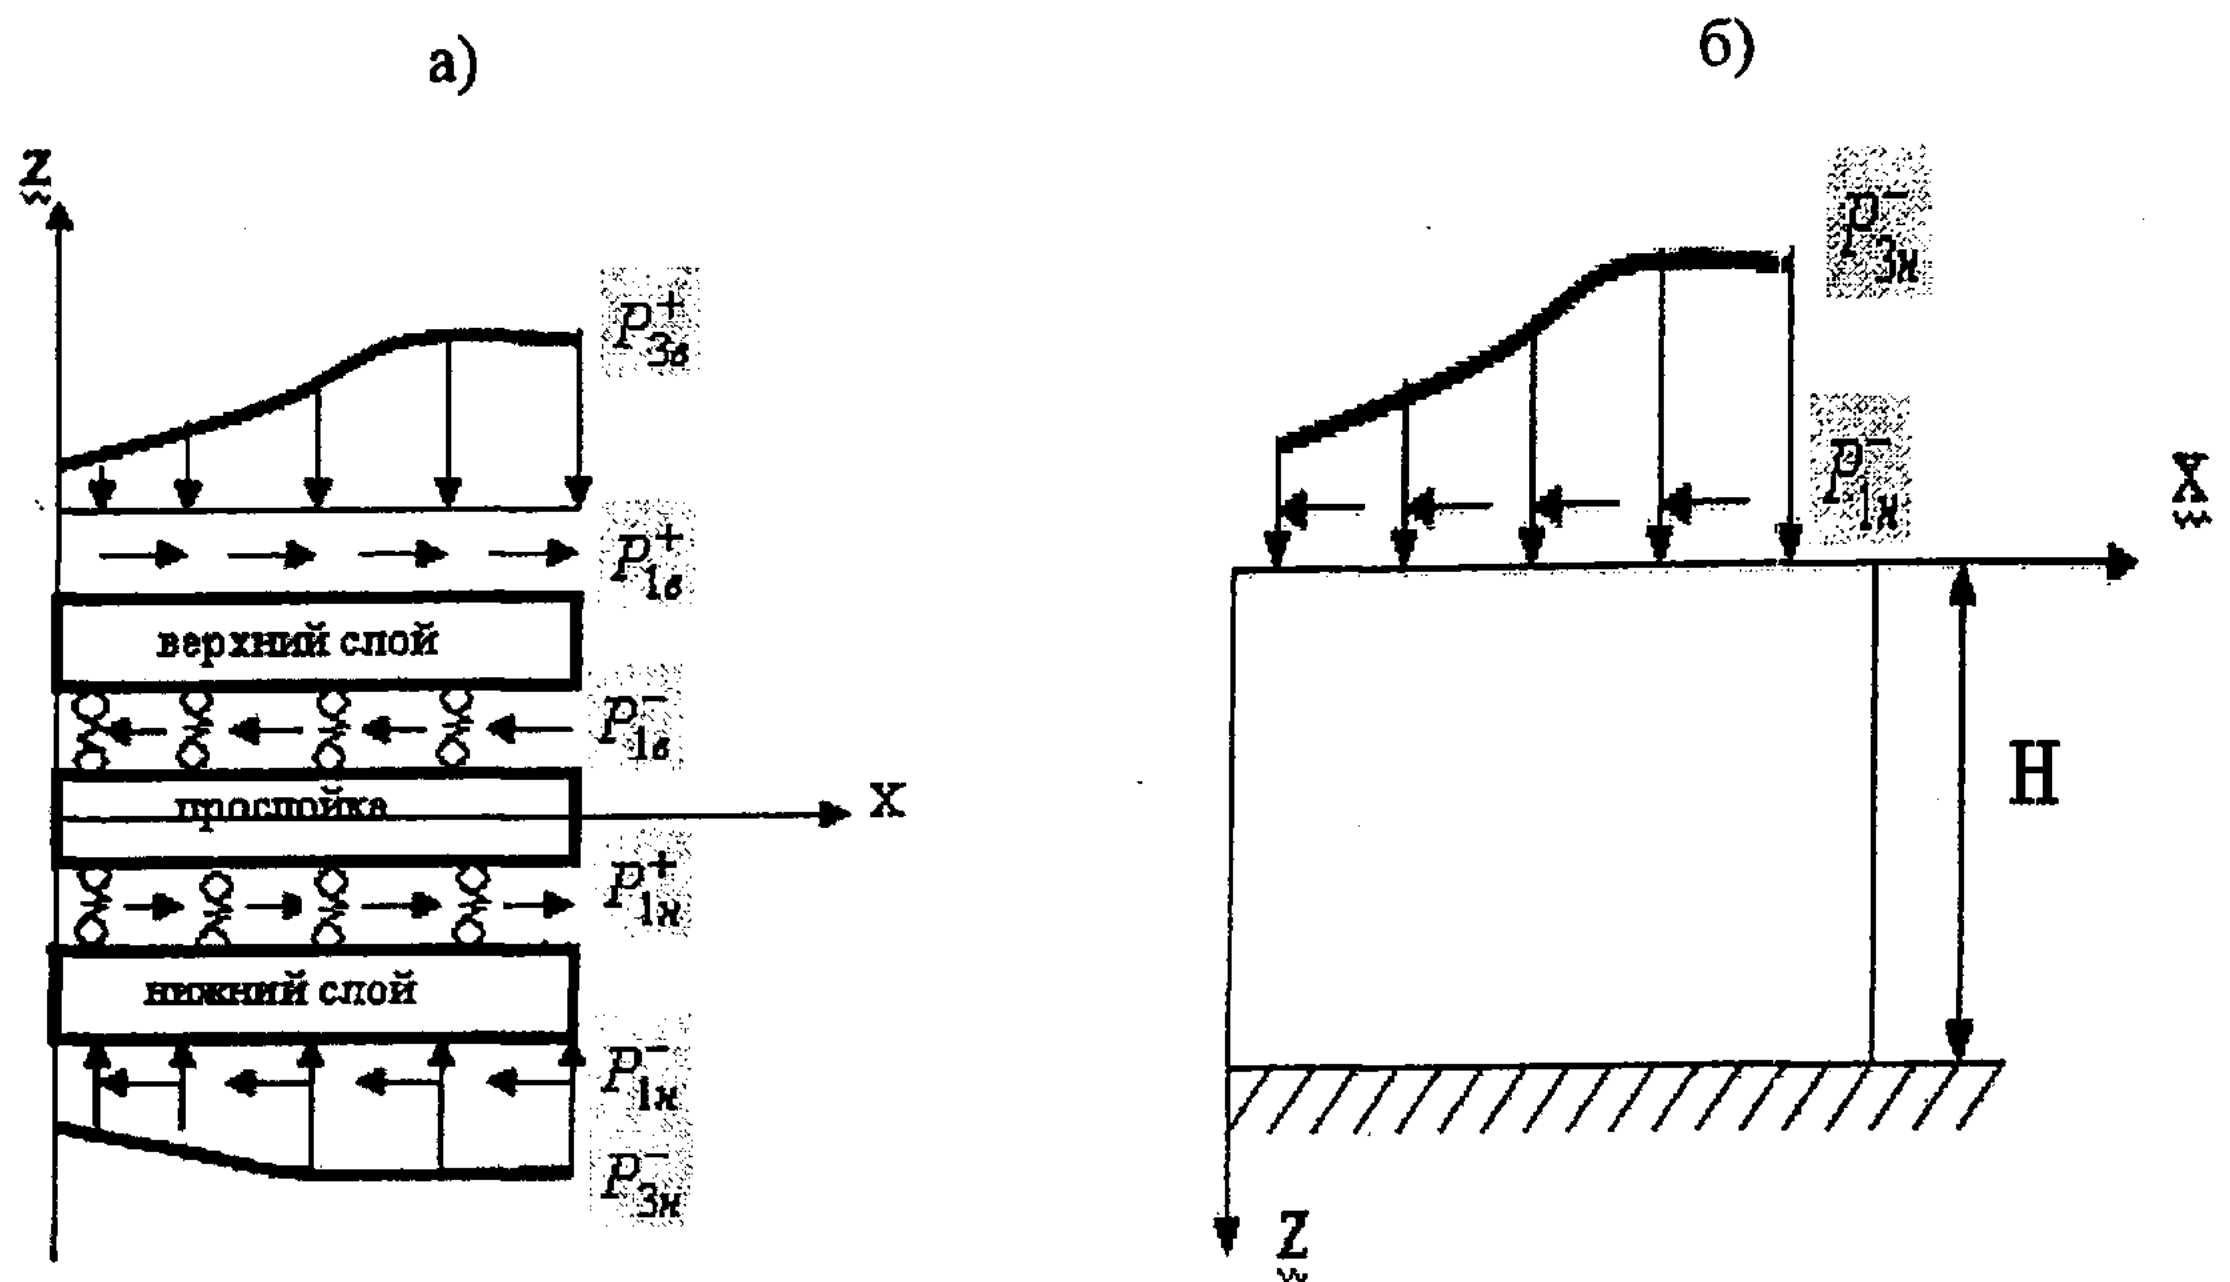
Расчетная схема трехслойной пластины на грунтовом основании.
